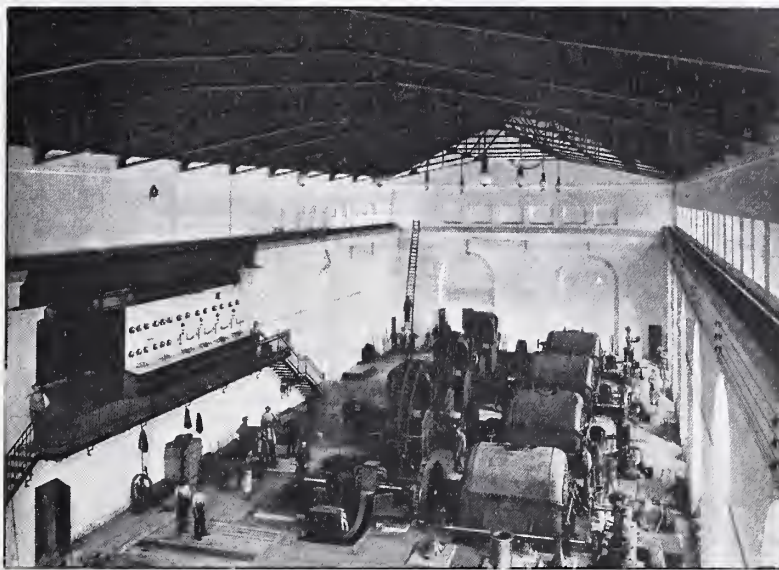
Ansicht des Maschinensaals in Paderno während der Montage.
